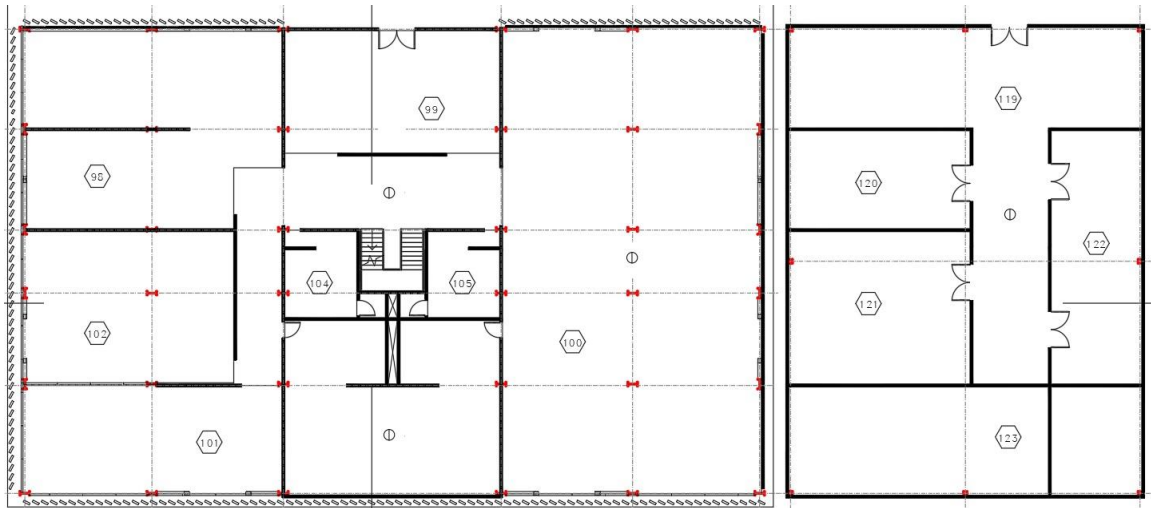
Sistema Megafonía Planta 1 Edificio Administrativo
